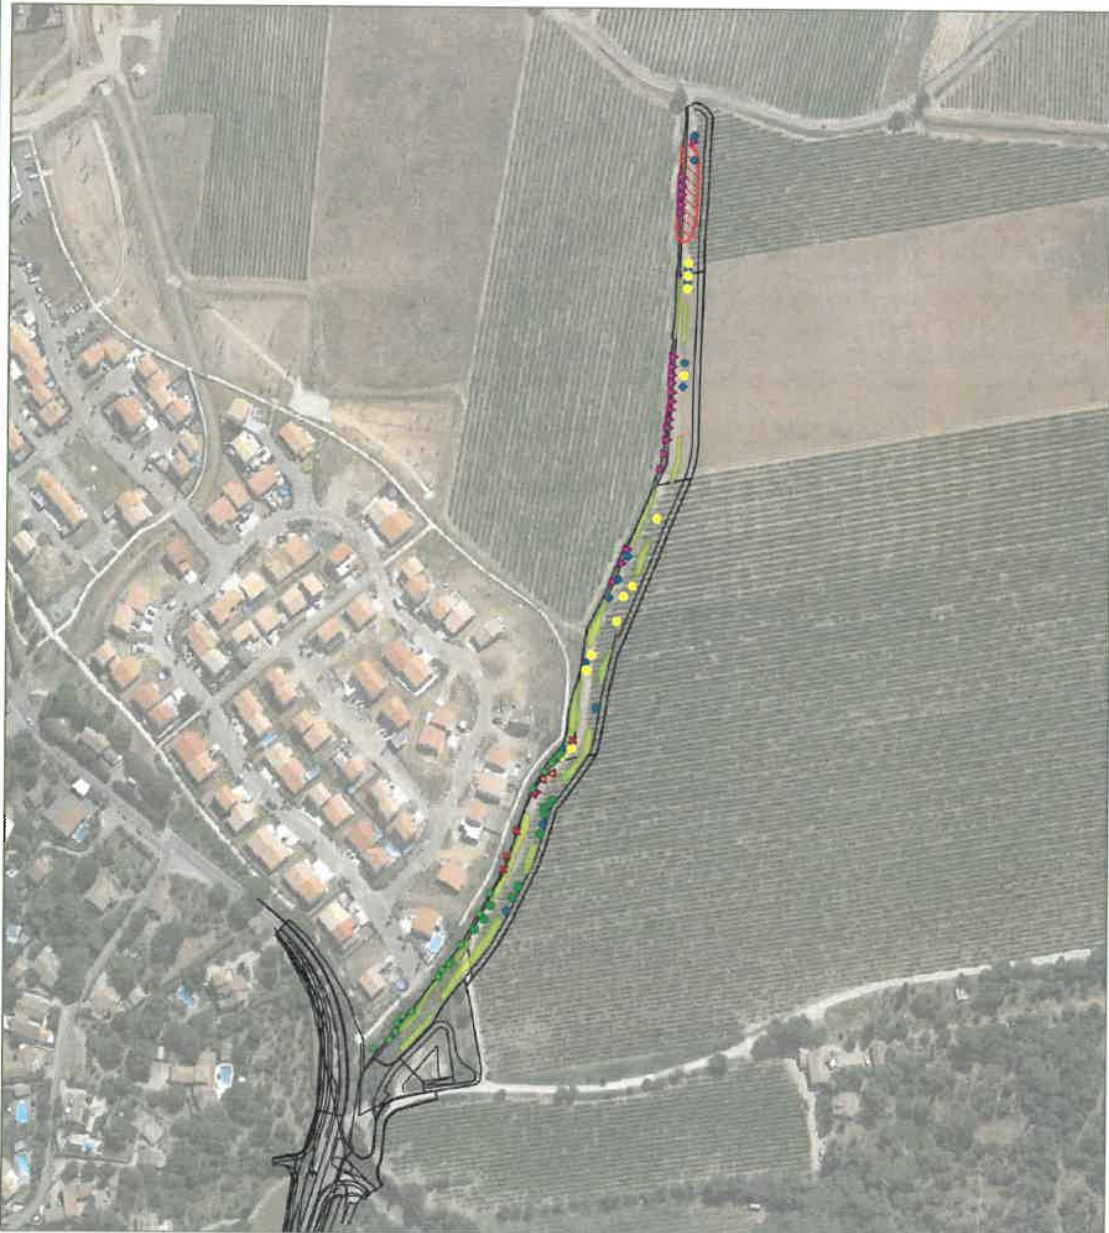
Plan de plantation au niveau du ruisseau du St-Laze
